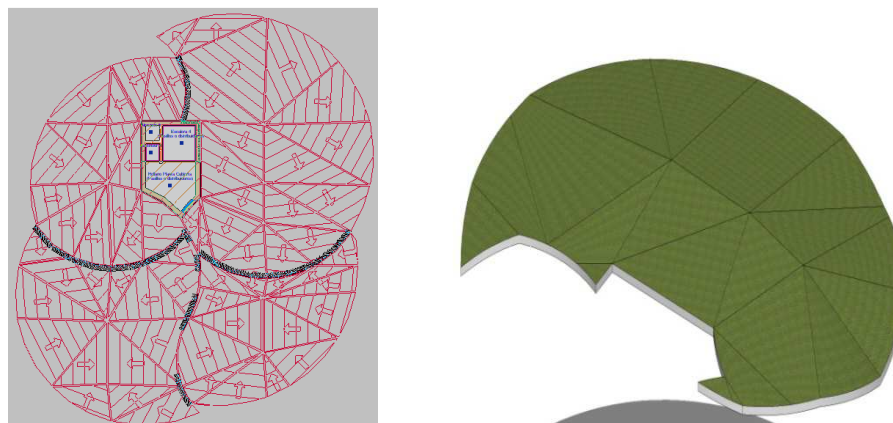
3D y plantas de las cubiertas verdes. Sistema estructural, sistema forjado y sistema acabado. Desarrollado con REVIT Y CYPECAD MEP.
